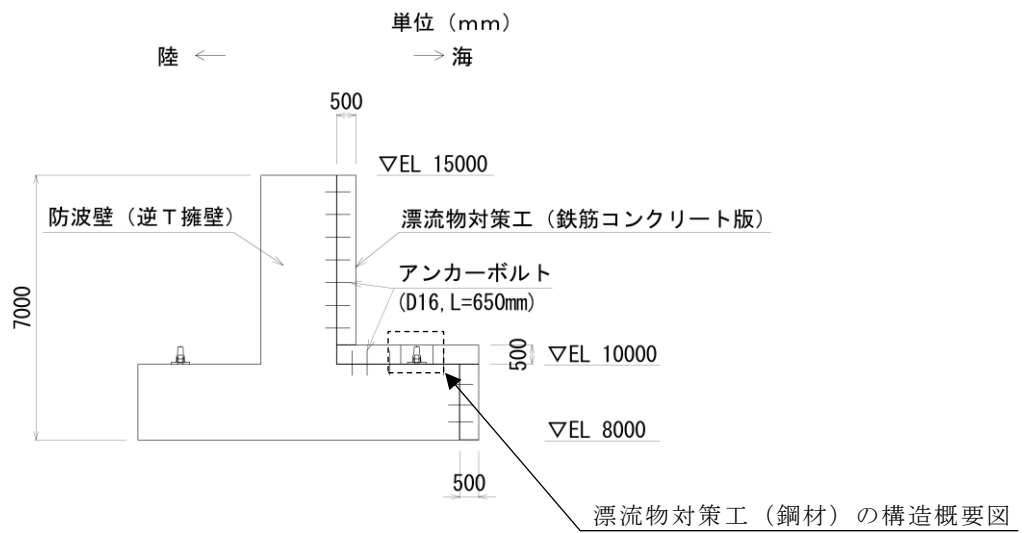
(2) 漂流物対策工（鉄筋コンクリート版）のアンカーボルト配置図（断面図）
